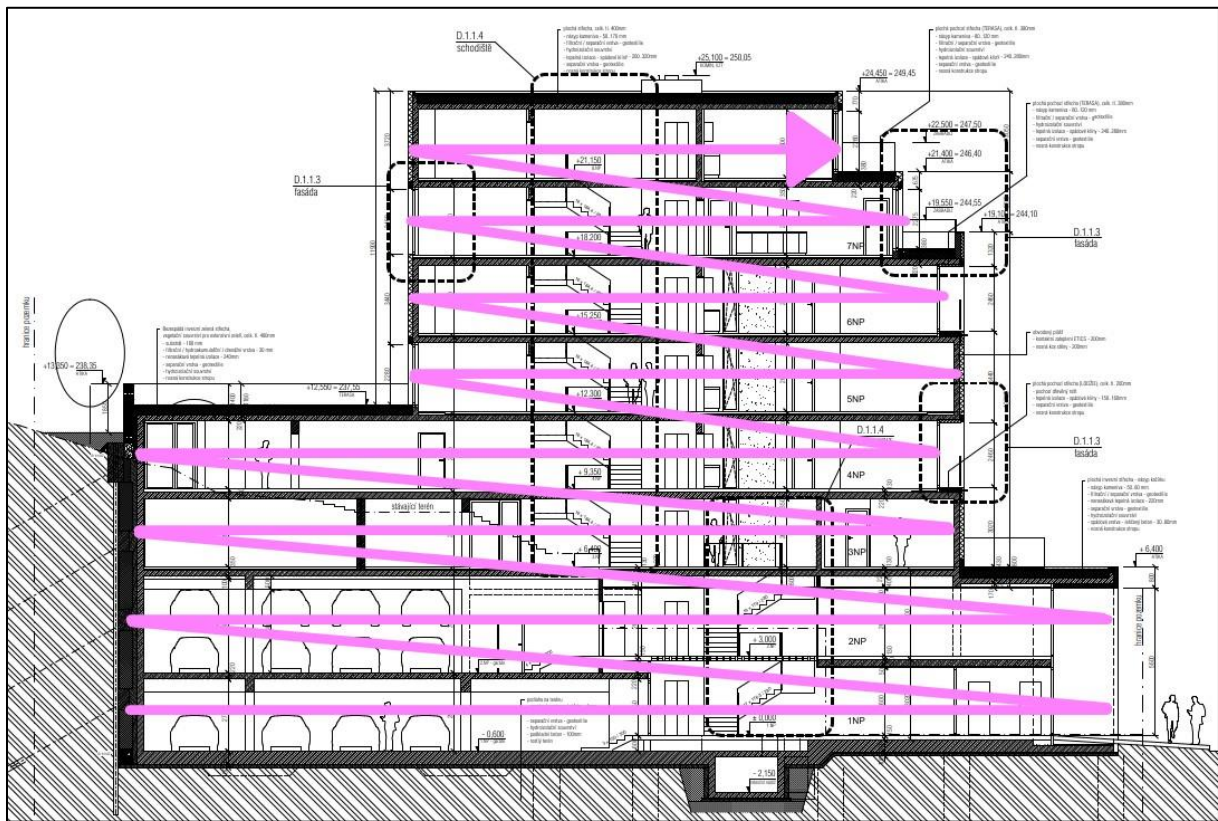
Technologické schéma pro TE 5 Hrubá vrchní stavba (Zdroj: Vlastní zpracování na základě PD)
